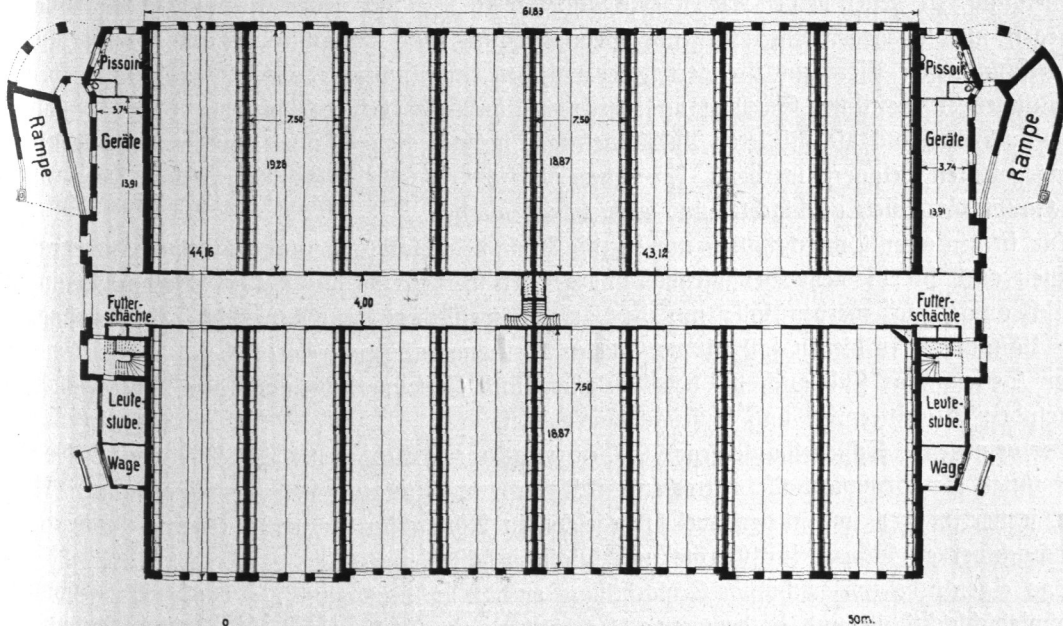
Zentralviehmarkt, Stallgebäude für Rinder, Grundriß.
